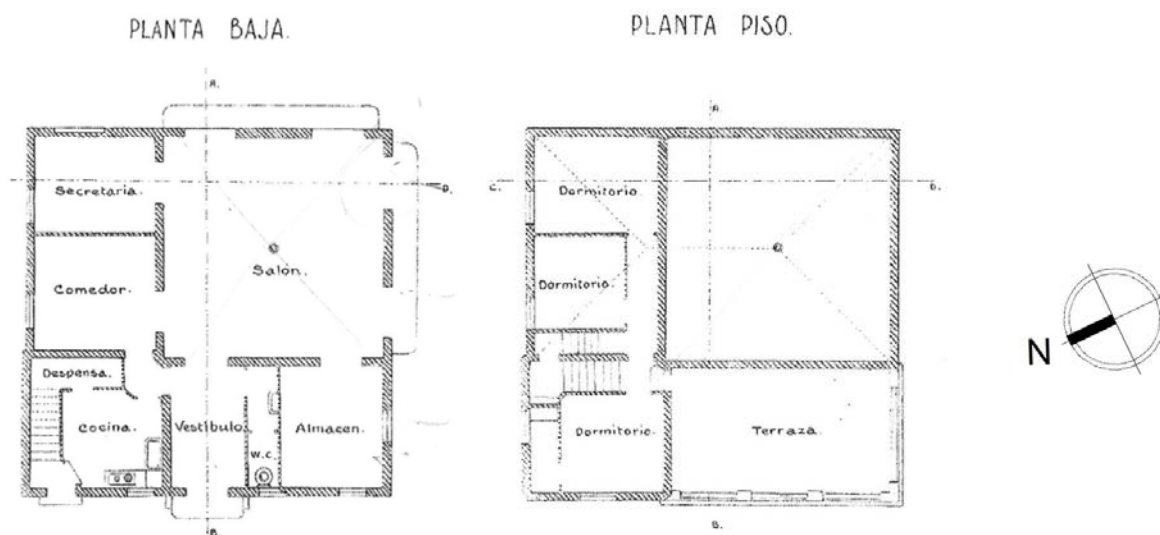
Plantas del proyecto de Carles Garau, 1927.
